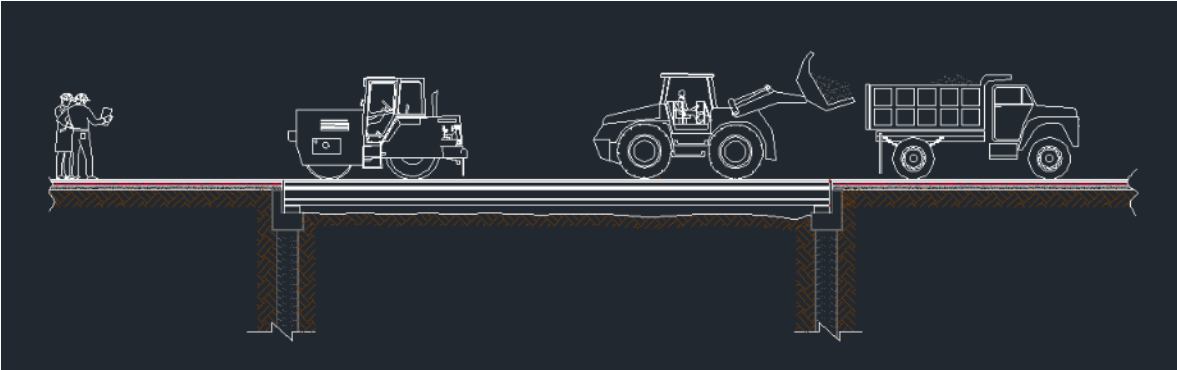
Colocación del parapeto y construcción de la guarnición
